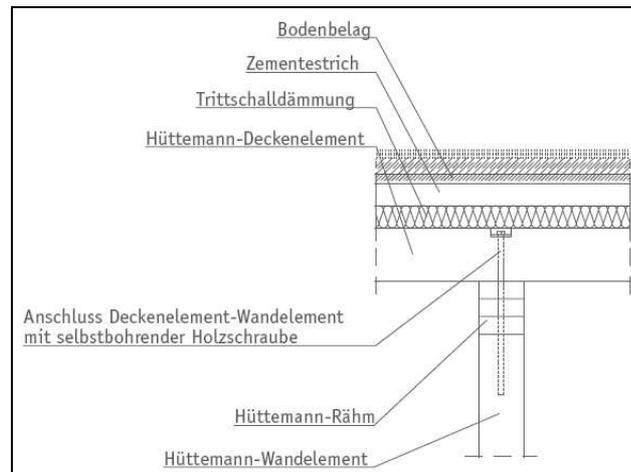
Detail Anschluss Deckenelement auf Wand
